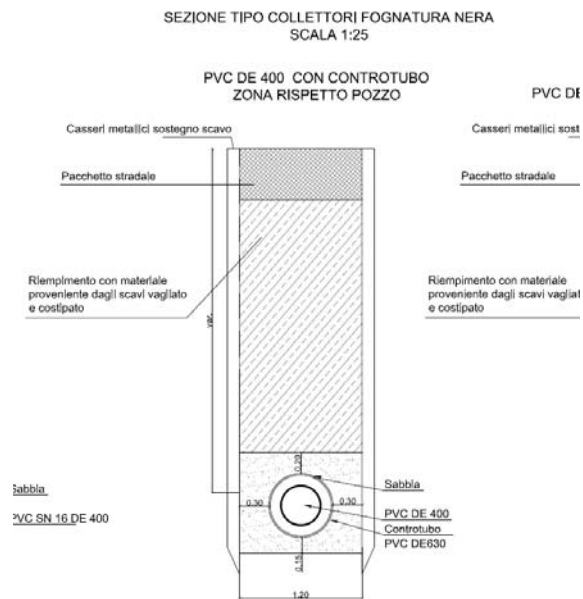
Sezione tipo collettori fognatura nera – PVC DE 400 con controtubo nella zona di rispetto allargata pozzo
